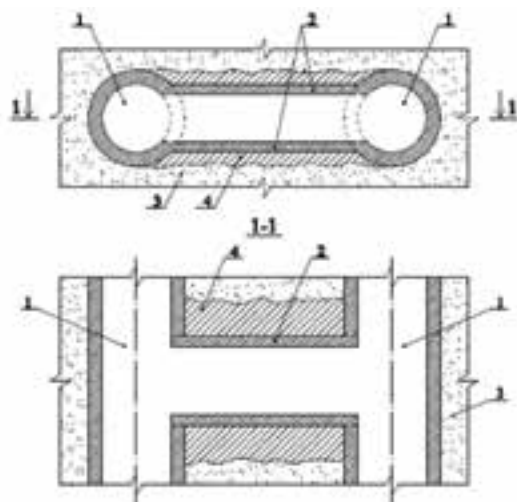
Схема закрепления неустойчивых грунтов межтоннельной сбойки перед проходкой:
